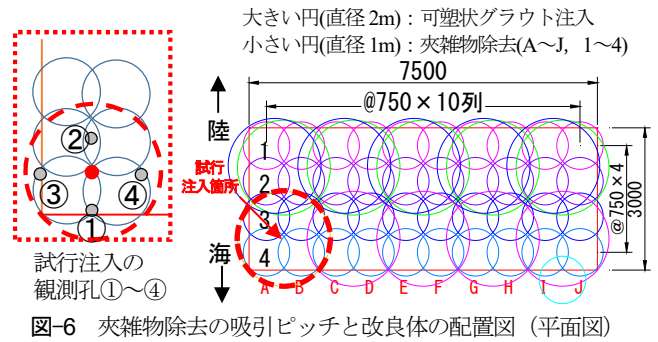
夾雑物除去の吸引ピッチと改良体の配置図（平面図）
